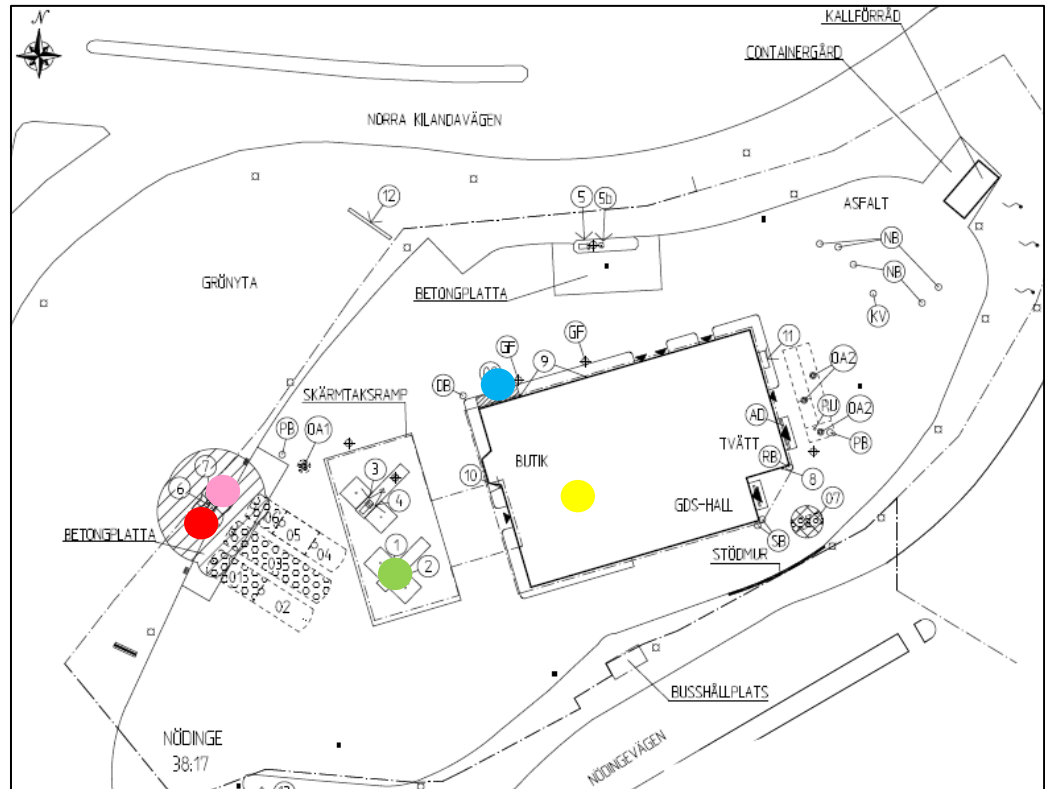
Befintlig bensinstation intill planområdet. (Preem, 2018)
